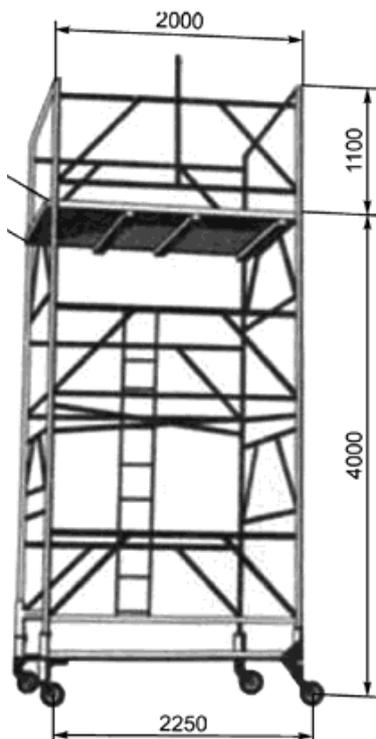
Схематичный вид передвижных средств подмащивания.
